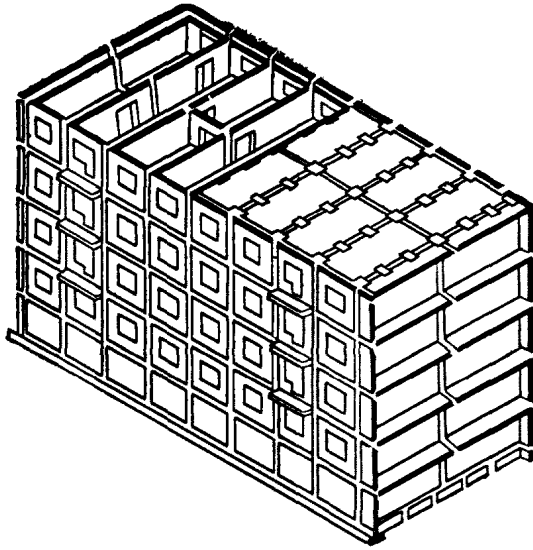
Конструктивная схема здания с поперечными и продольными наружными несущими стенами (сплошная внутренняя продольная стена отсутствует)
